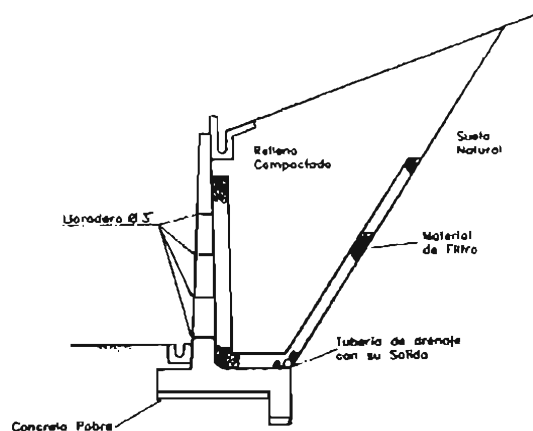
Esquema típico de un muro de concreto armado con su sistema de subdrenaje.
